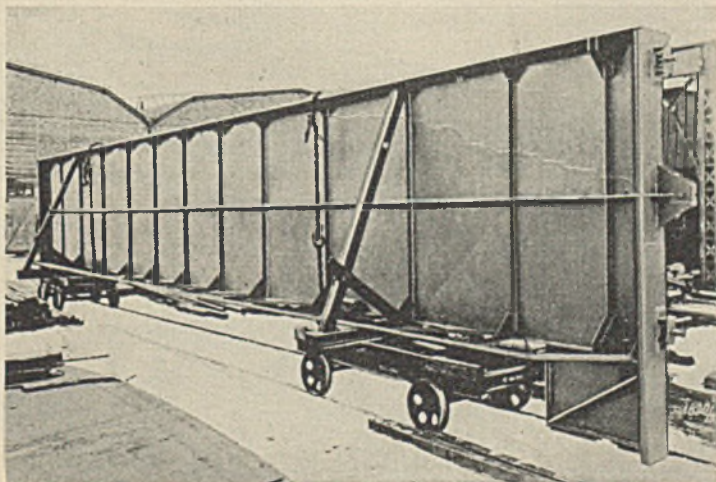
21 m lange geschweißte Abschlußschürze einer Fabrikhalle.
